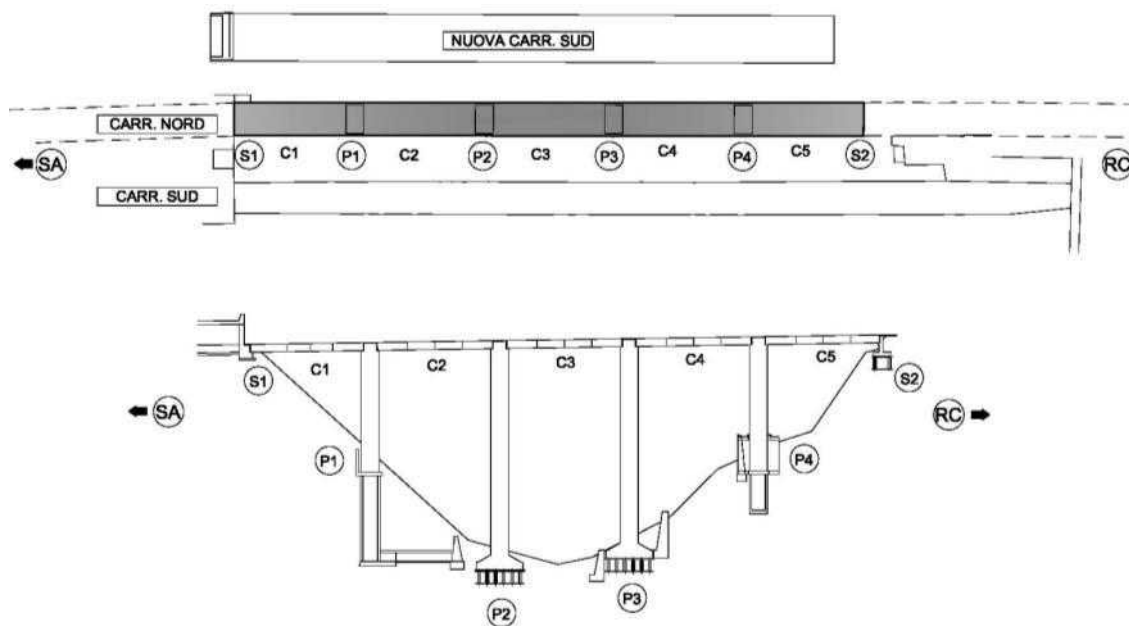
Profilo longitudinale e pianta carreggiata Nord
